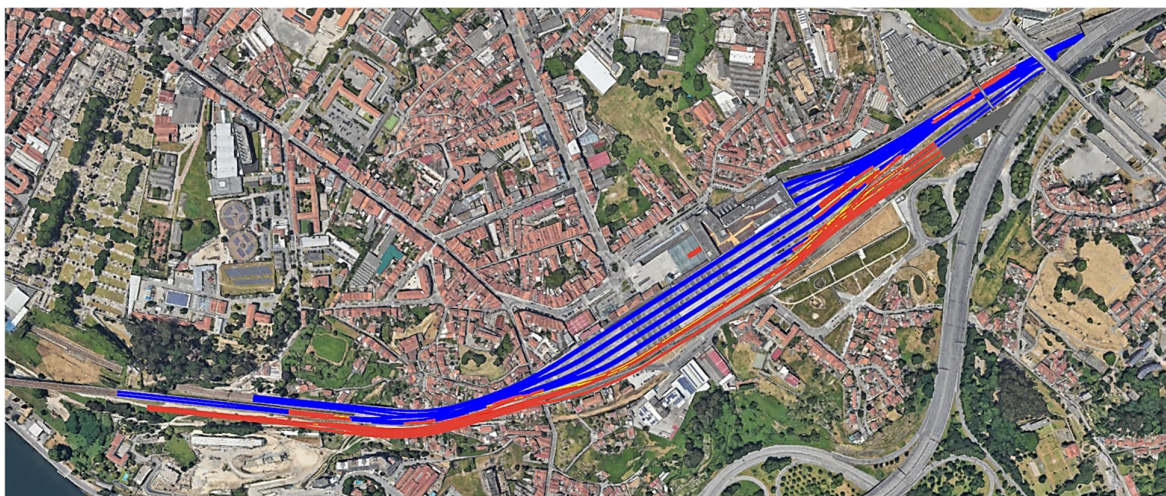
Estação de Campanhã – Situação Futura – Saída – Lado Norte
